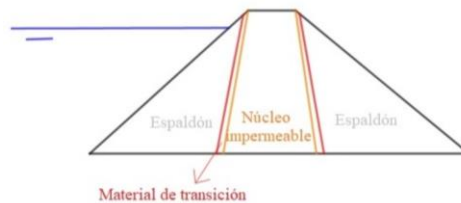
Sección de presa de núcleo. Fuente: [2]
